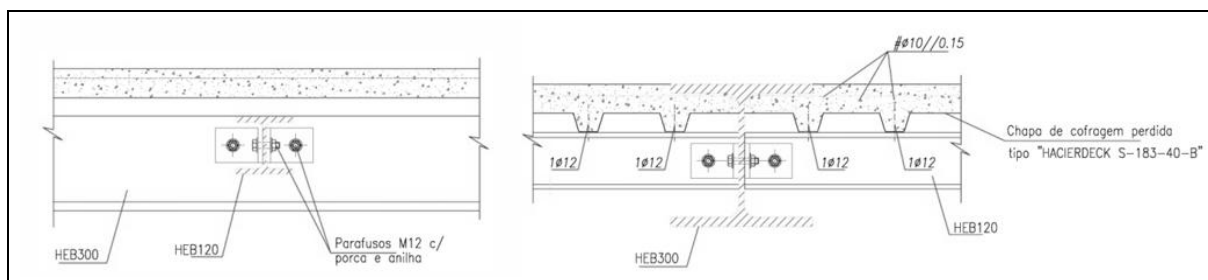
Pavimento misto de aço e betão (zonas húmidas) [99]
